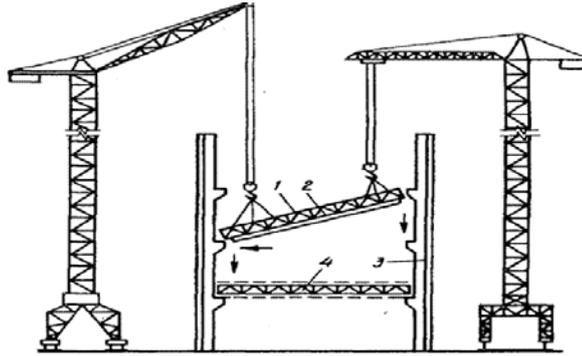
Монтаж тяжёлых конструкций двумя башенными кранами:
